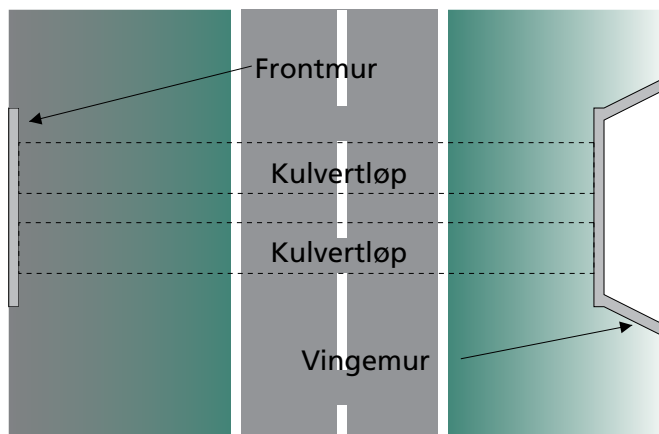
Element F Konstruksjoner i fylling, Rørkulvert med to løp og vingemur
